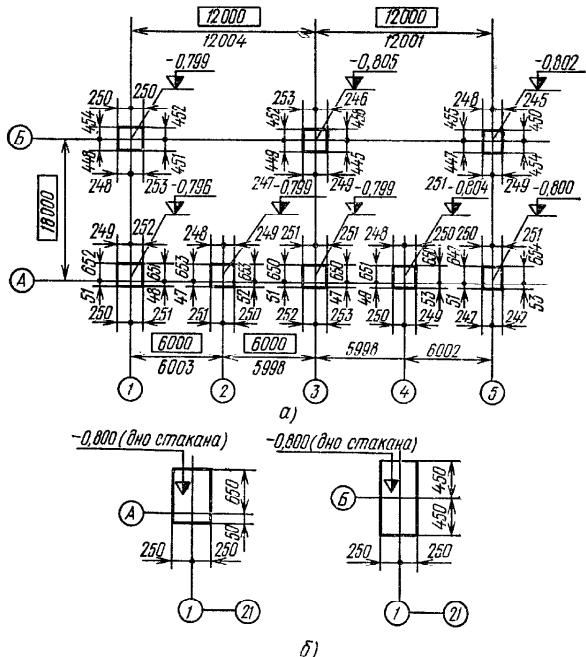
Исполнительная схема фундаментов железобетонного каркасного здания:
